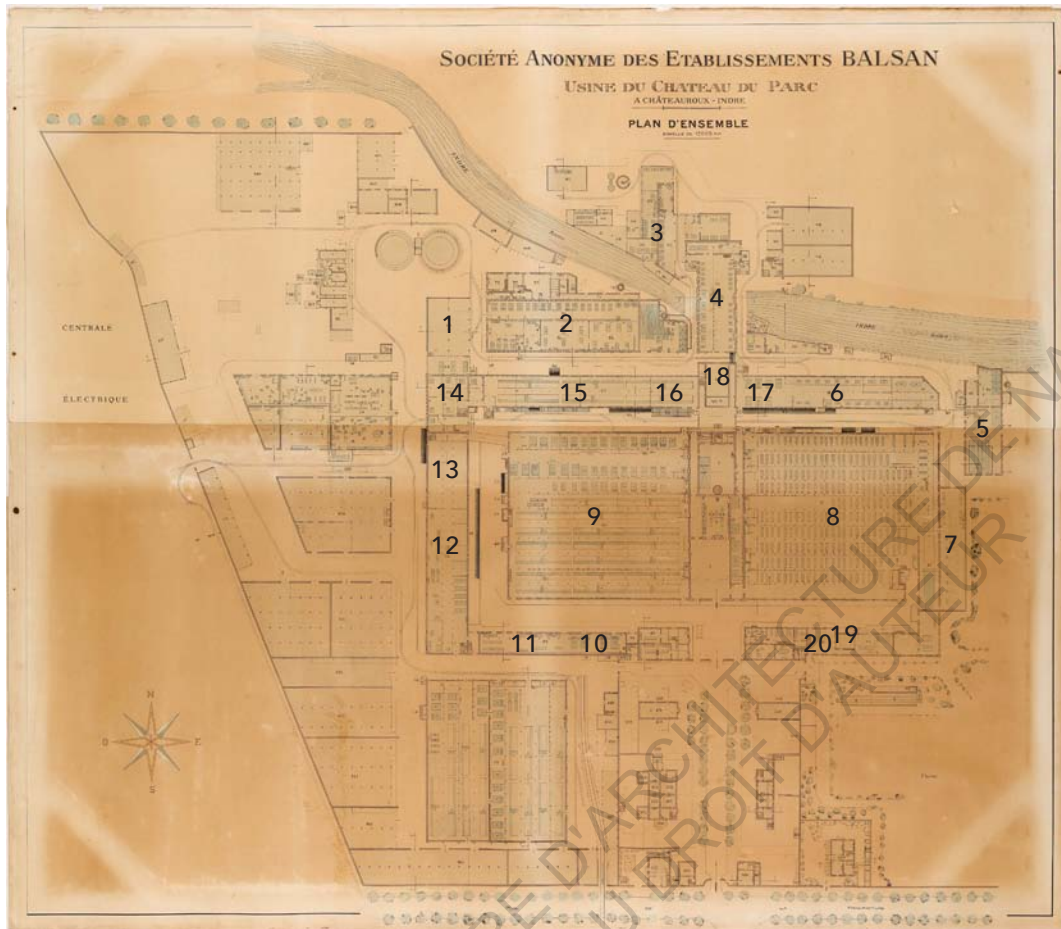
Plan de l'usine Balsan à la fin du XIXème siècle (AM de Châteauroux)
